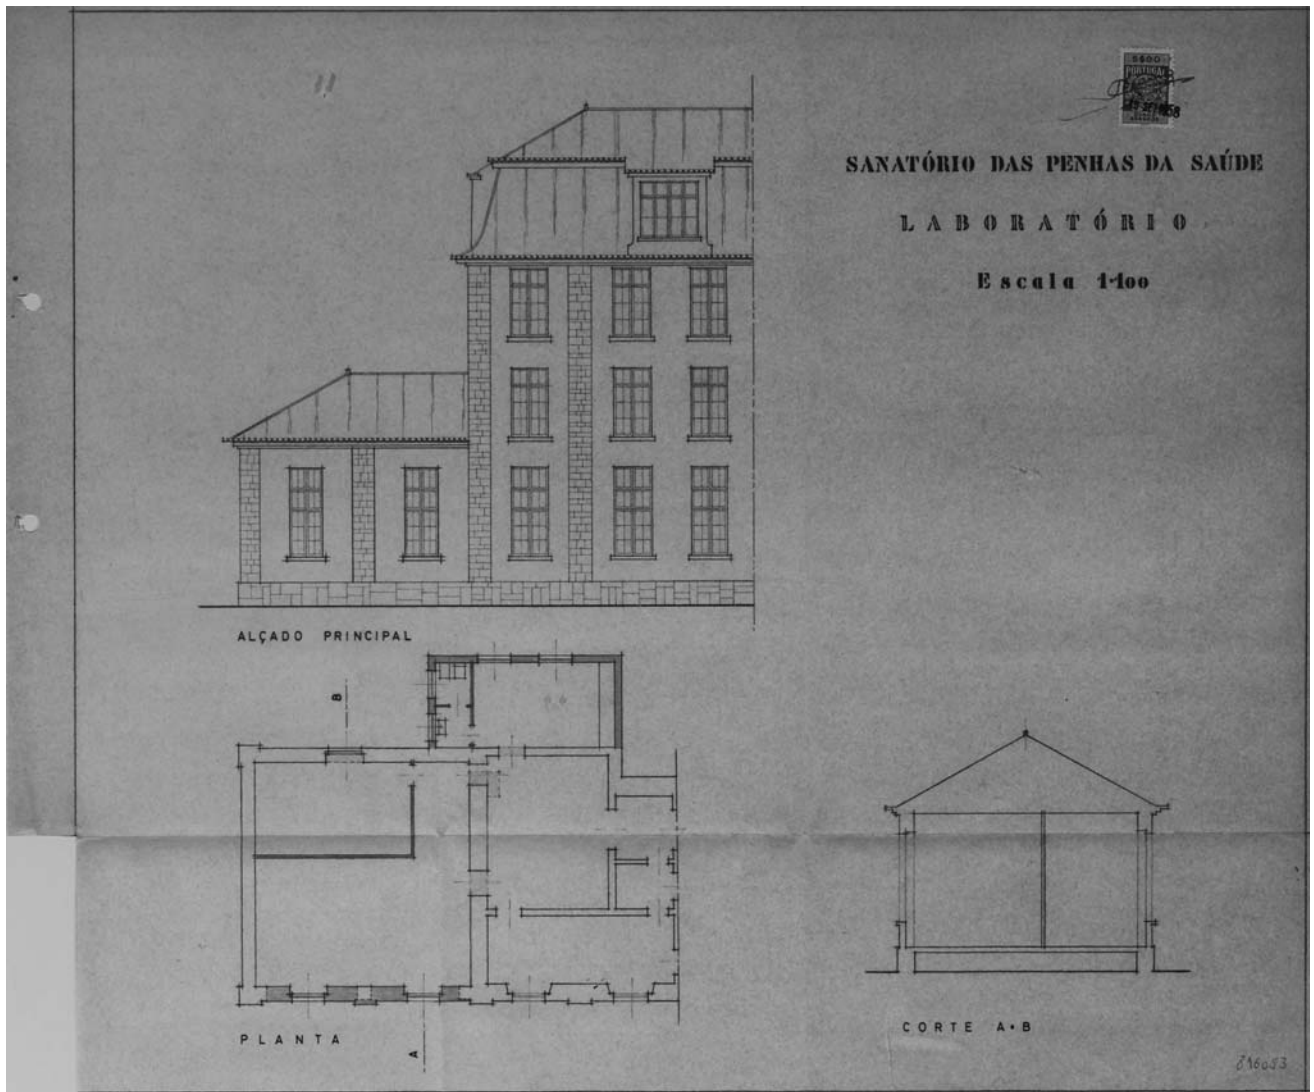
Laboratório - Alçado principal, planta e corte AB. 1958. 1958(m.). SIPA: DES\_816053.
